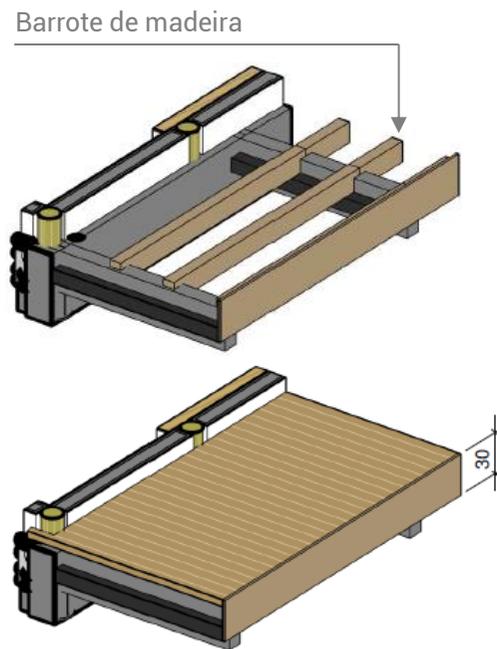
Detalhe estrutural da circulação externa das Fachadas Norte e Sul.
